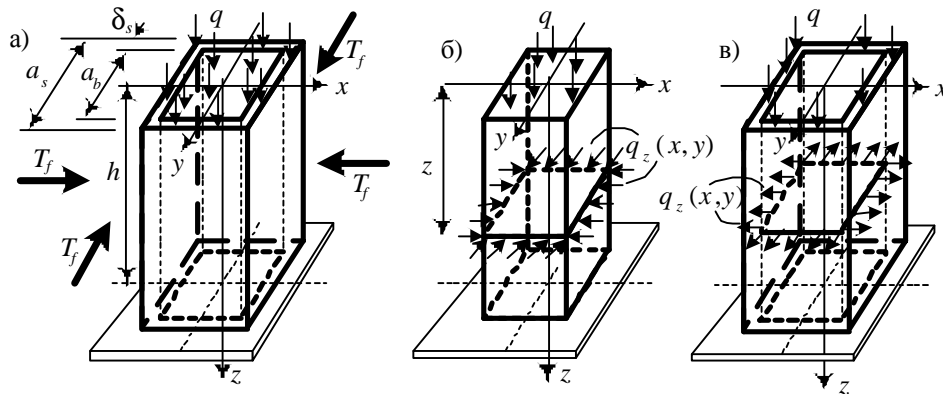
Расчетная схема консольной сталебетонной колонны: а – колонна; б – бетонное ядро; в – стальная обойма
